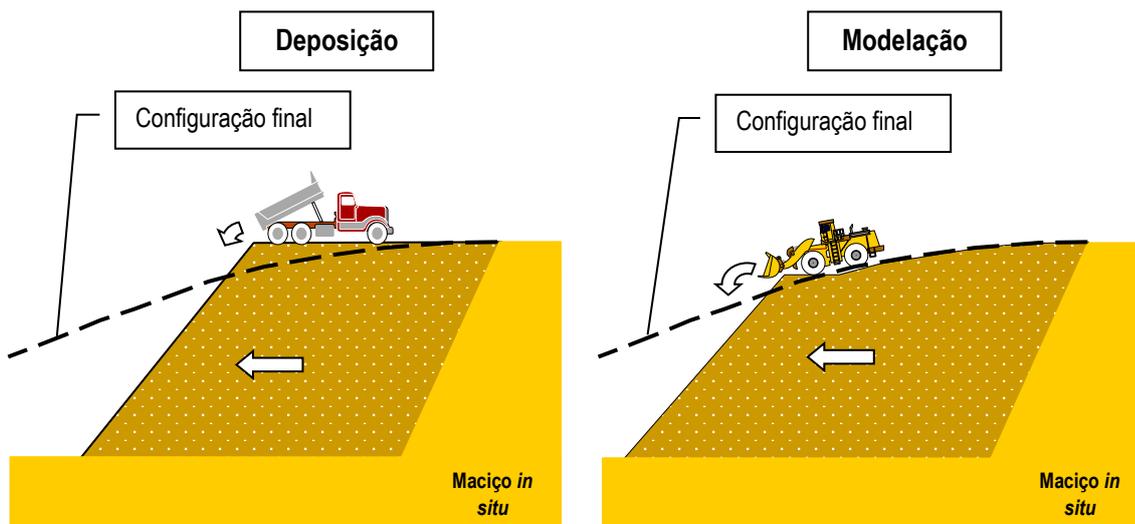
Perfil esquemático do método construtivo para o preenchimento dos vazios de escavação.
